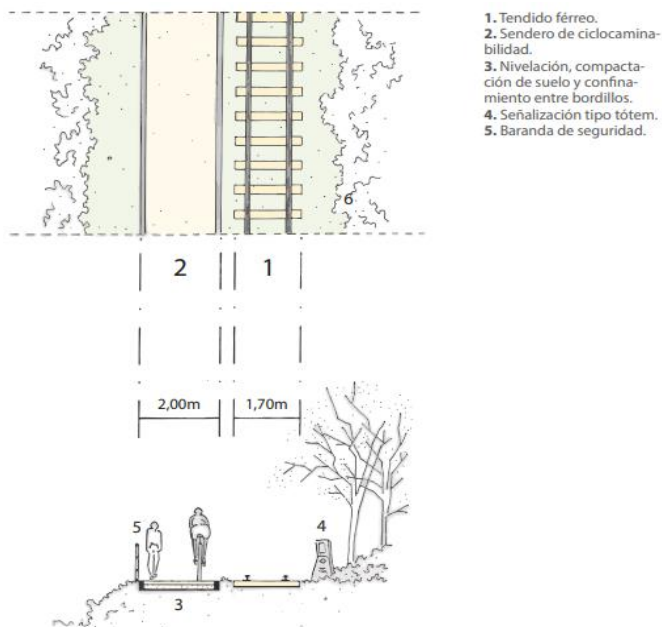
Alternativa de intervención para la vía verde conrada con bordillos, paralela a la vía férrea.
